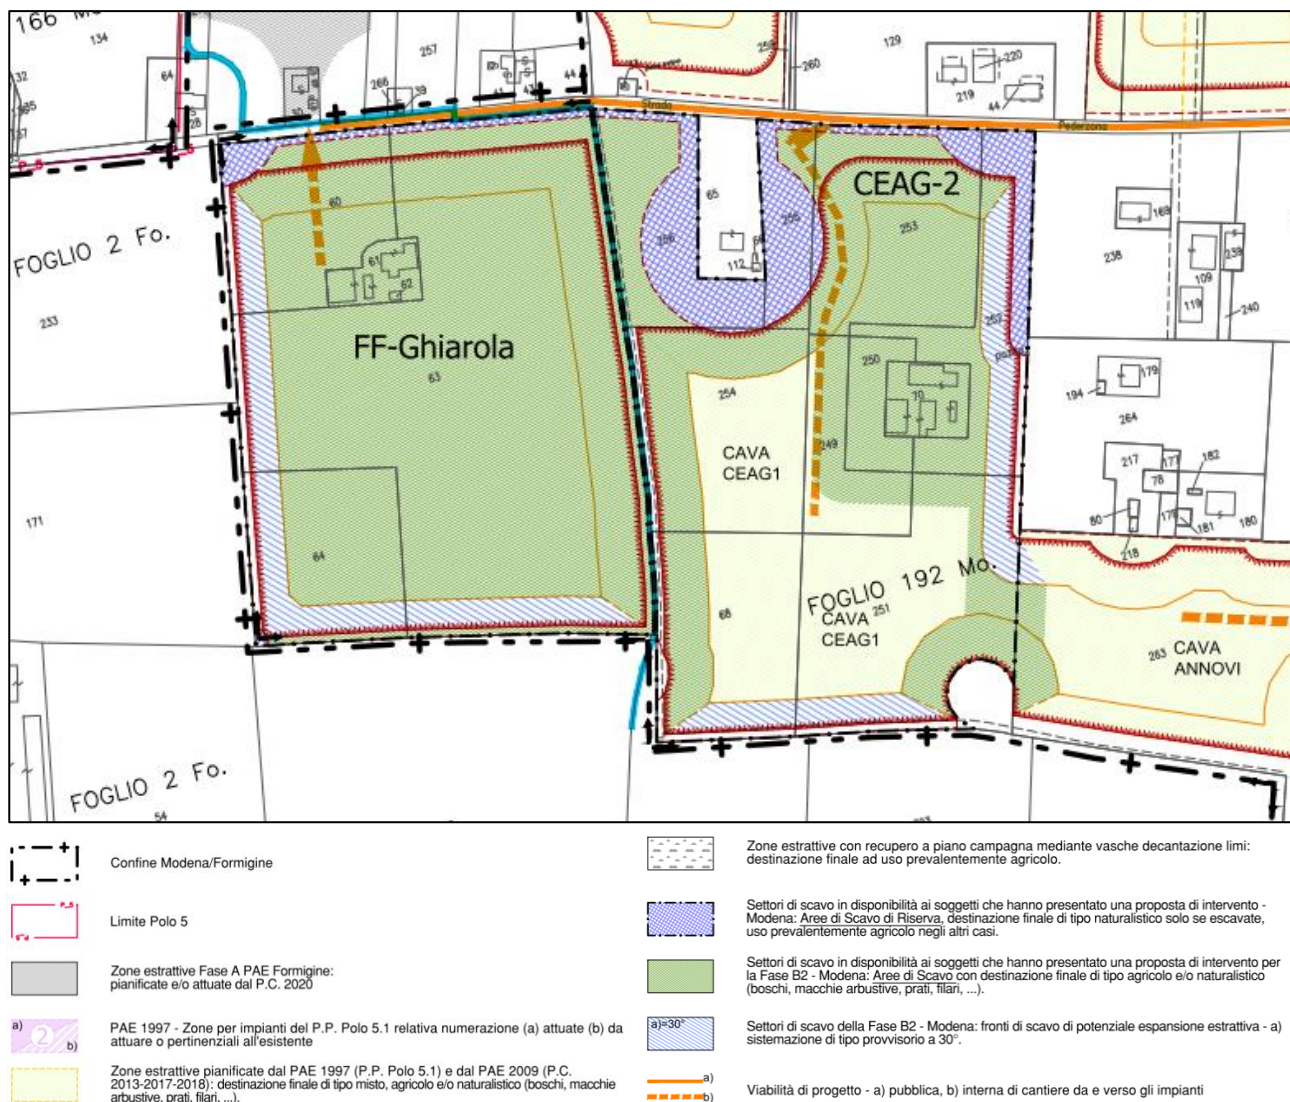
PC 2024 – Estratto tavola 2.2.j “Progetto – Planimetrie delle destinazioni d'uso finali”
